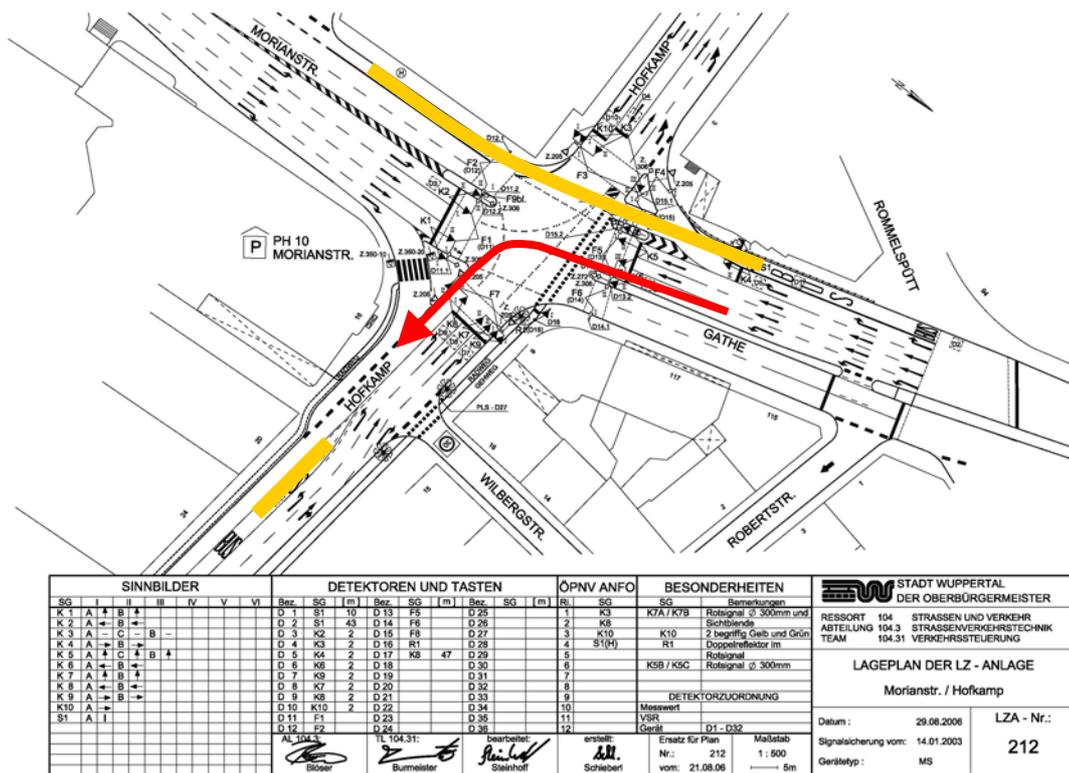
Signallageplan LZA 212, Morianstraße/Hofkamp
